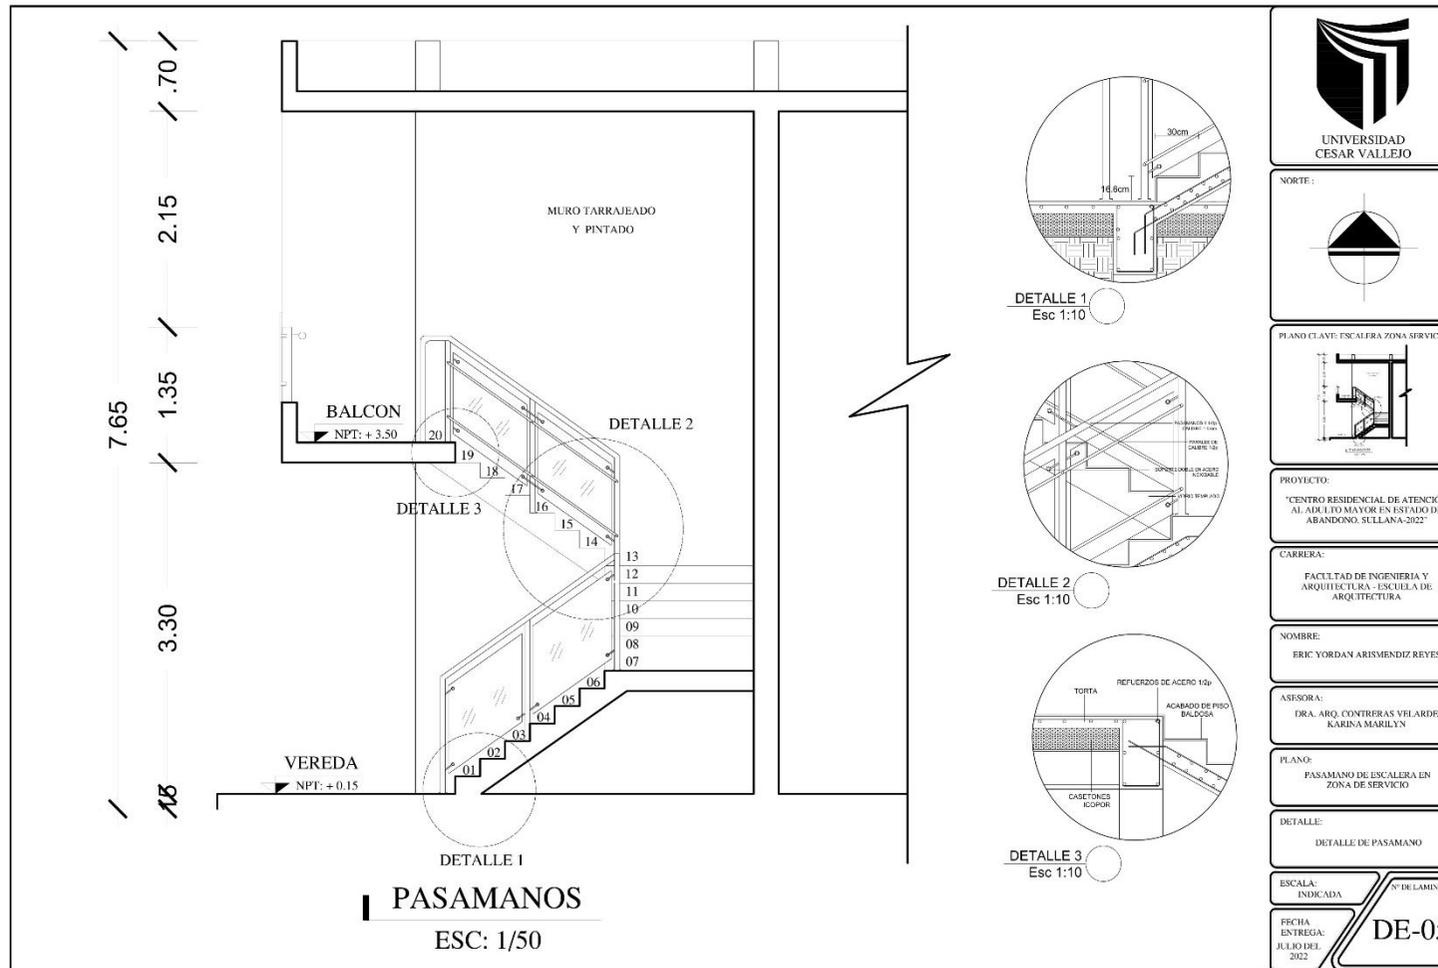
Plano de servicio - detalles de pasamano DE – 06
